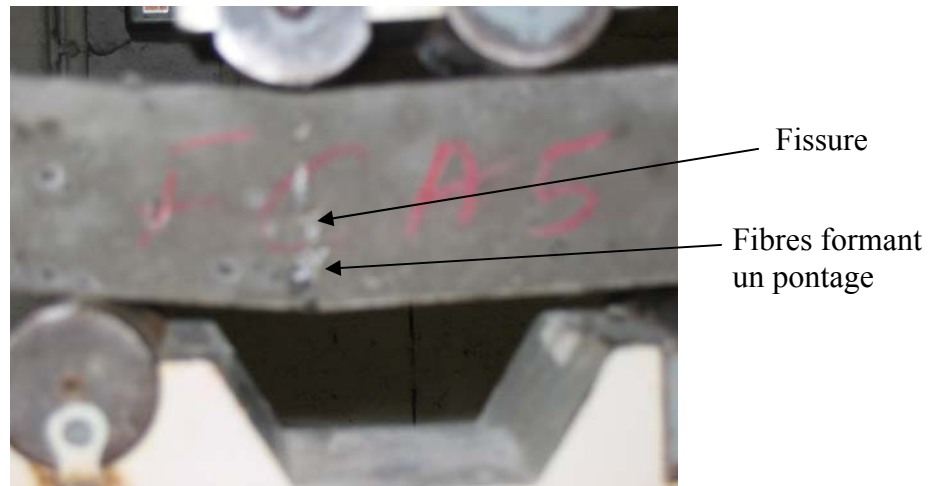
Photo montrant la rupture d'un échantillon fibré lors d'un essai de flexion 4 points
